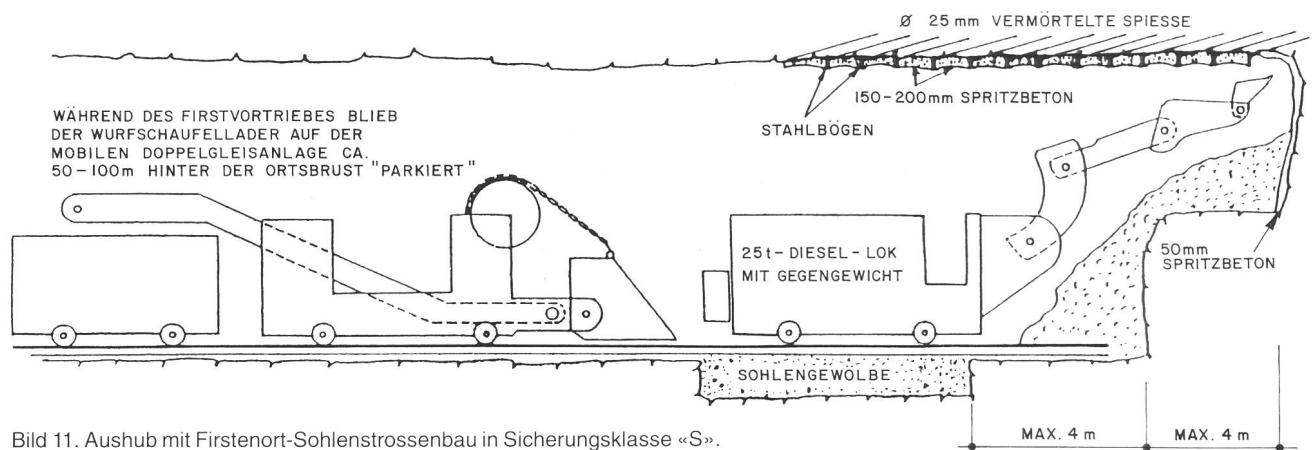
Aushub mit Firstenort-Sohlenstrossenbau in Sicherungsklasse «S».
